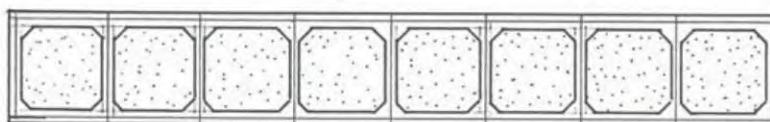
Dessin du profil d'une poutre à partir de la position des suspentes.
